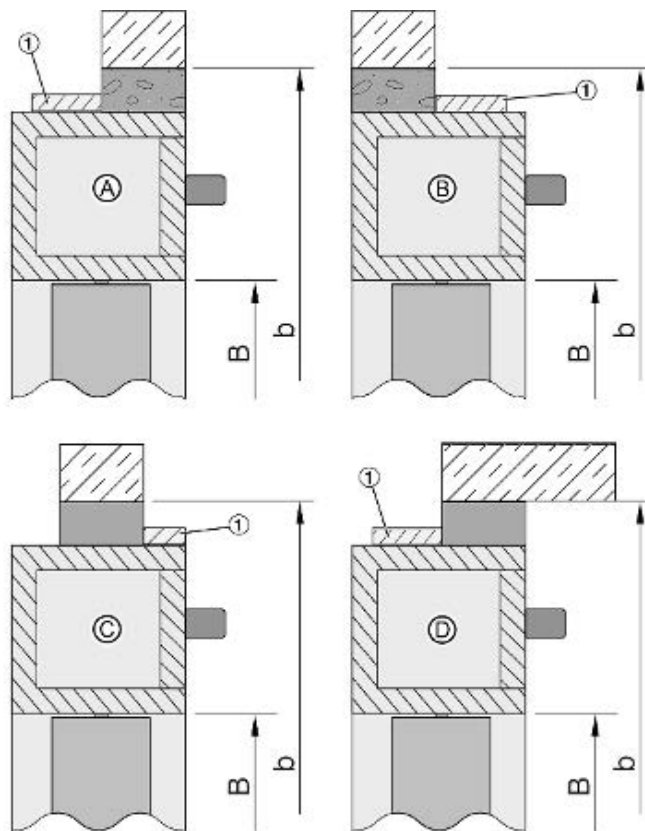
Profondità di installazione (disegno: sezione dall'alto)
